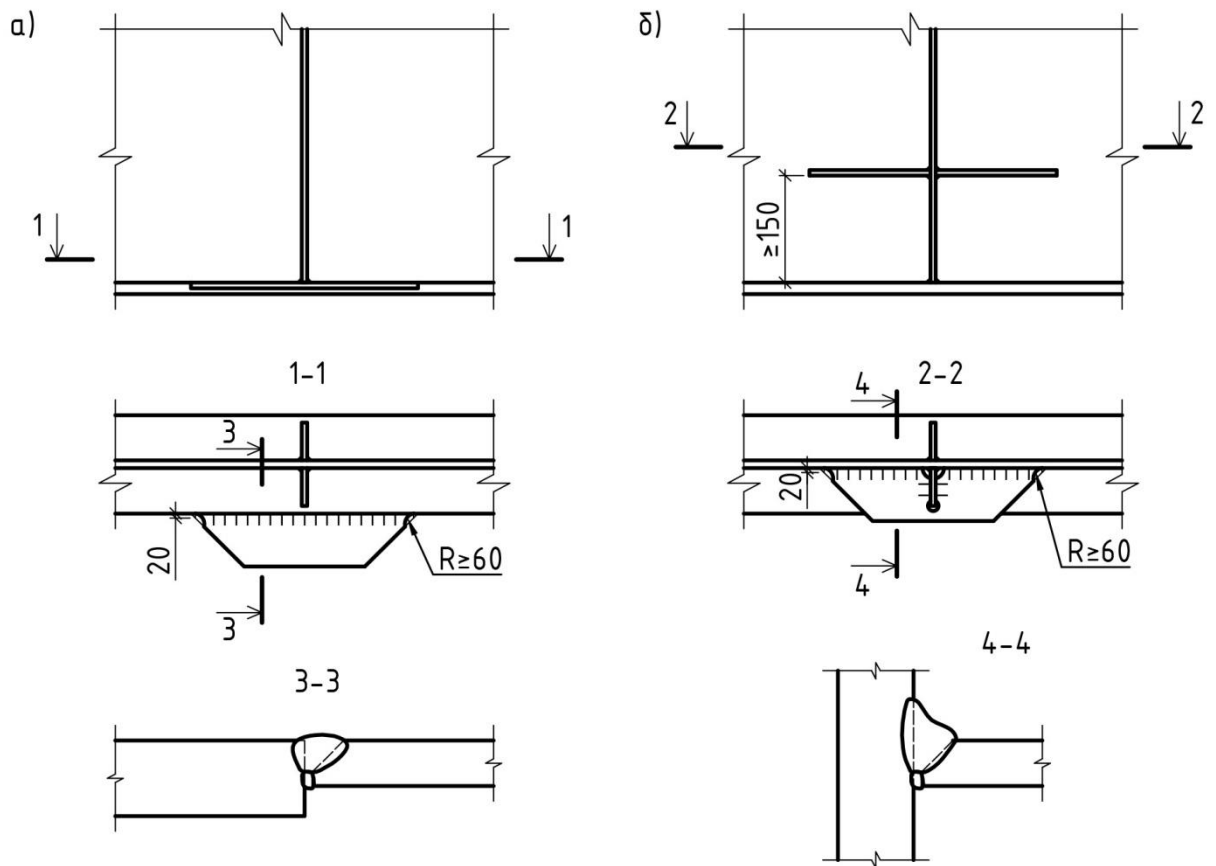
Схеми кріплення фасонки до поясу та стінки головної балки:
